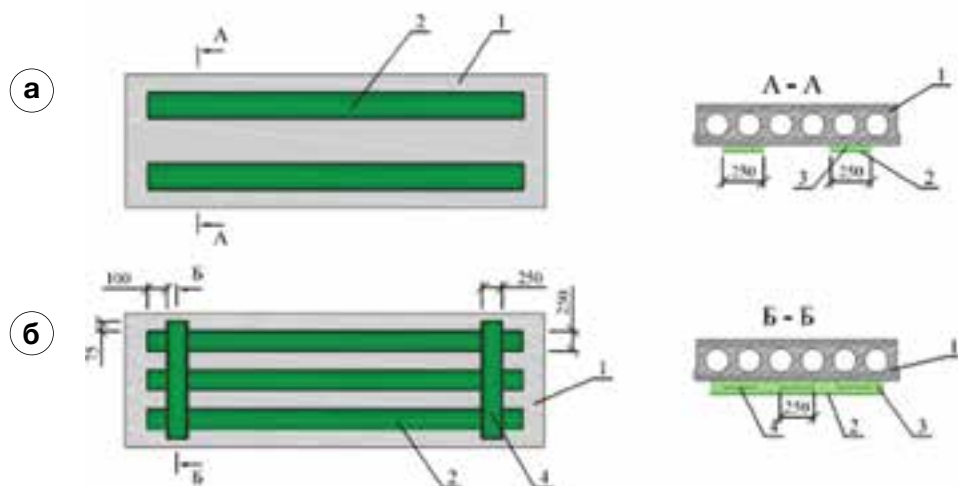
Схема усиления сборных ж/б плит перекрытия холстами: а) продольными холстами; б) продольными и поперечными холстами.
